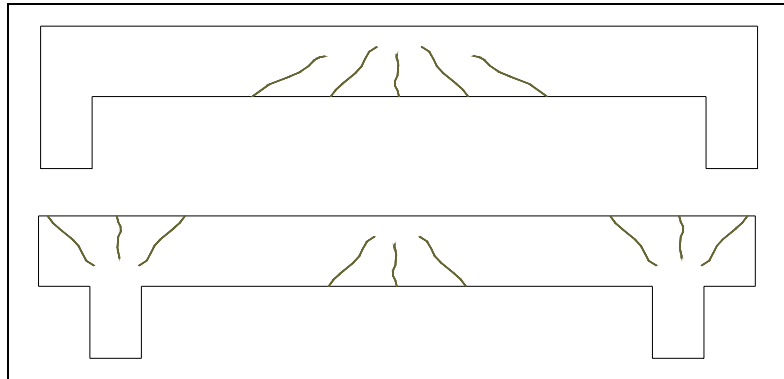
Grietas estructurales en vigas (Do Lago 1997)
